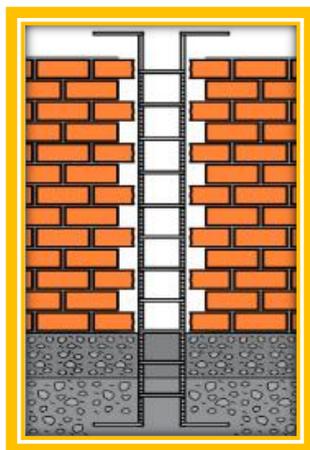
Muro con tipo de conexión dentado en interacción del muro con el acero de la columna.
